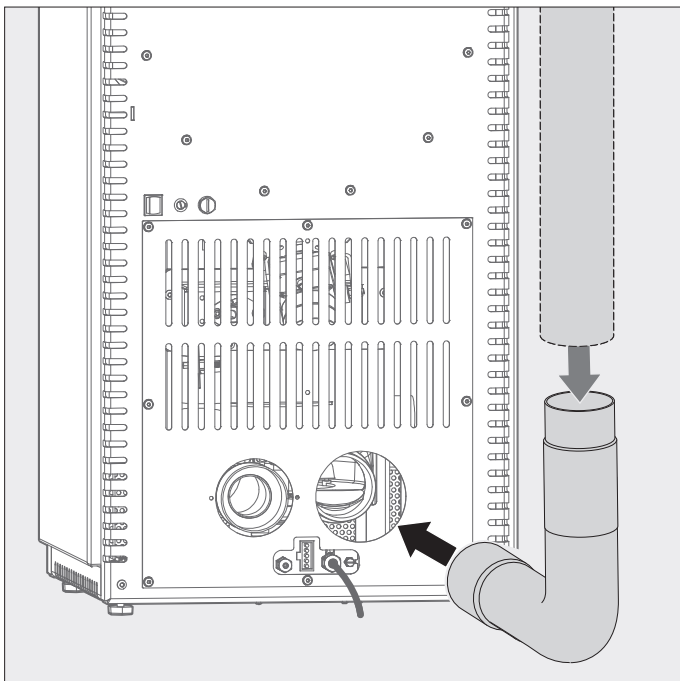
Placer la tubulure d'échappement sur le raccord (sur site)
